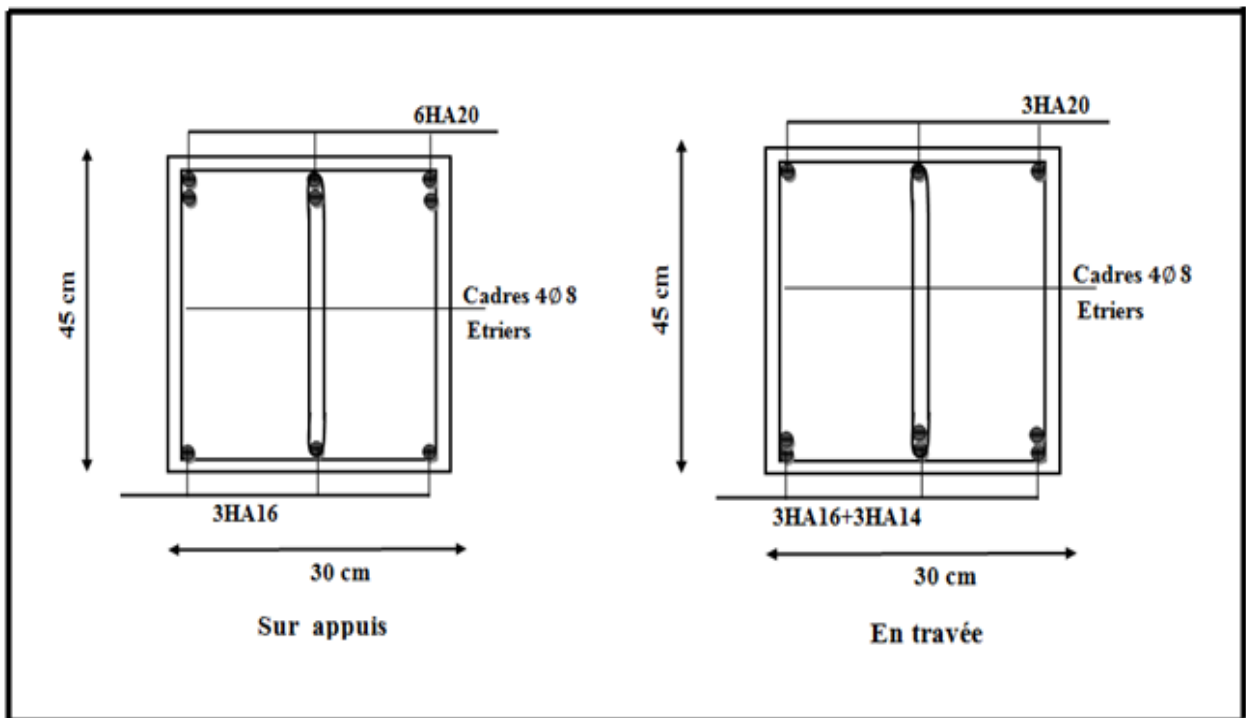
Schéma de Ferrailage des poutres secondaires.
